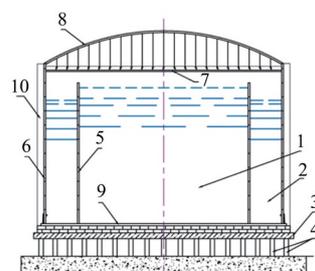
Устройство для хранения сжиженных газов: 1 — основной резервуар для хранения СПГ; 2 — межстенное (резервное) пространство, или аварийный резервуар; 3 — железобетонный ростверк; 4 — сваи; 5 — внутренняя стенка аварийного резервуара; 6 — наружная стенка аварийного резервуара; 7 — внутренняя подвесная крыша устройства; 8 — наружная купольная самонесущая крыша устройства; 9 — общее днище устройства; 10 — наружная теплоизоляция
